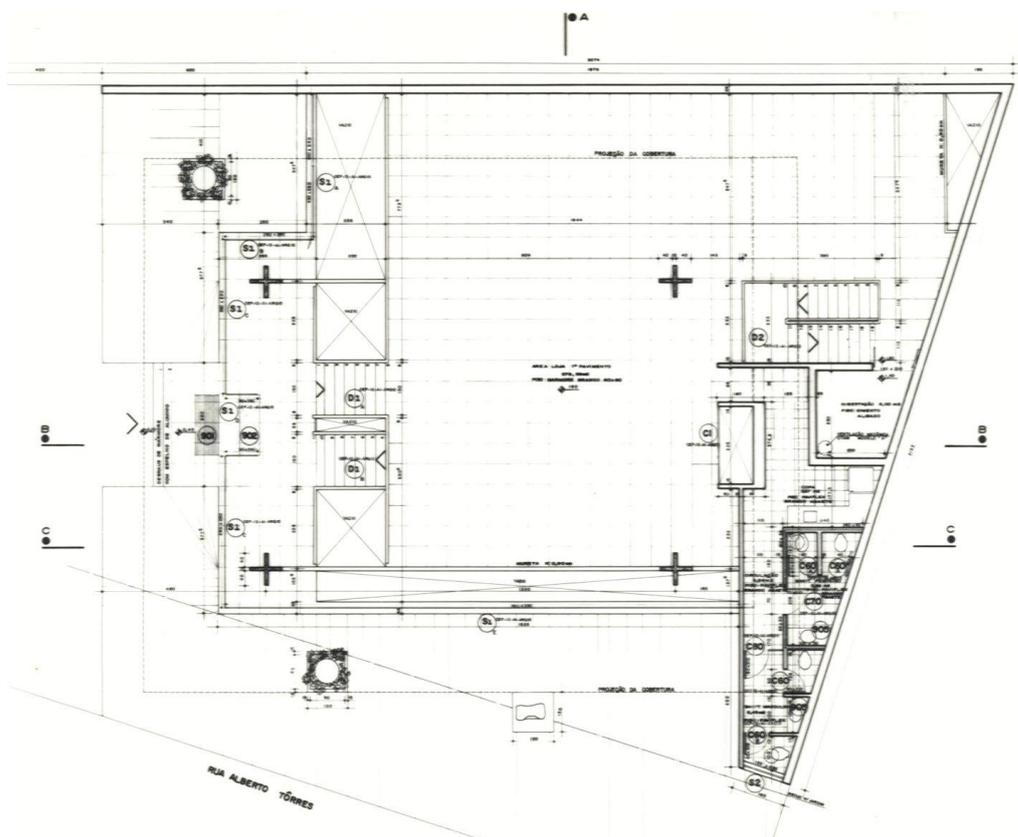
Planta Baixa CEF José do Patrocínio. Fonte: acervo Debiagi
